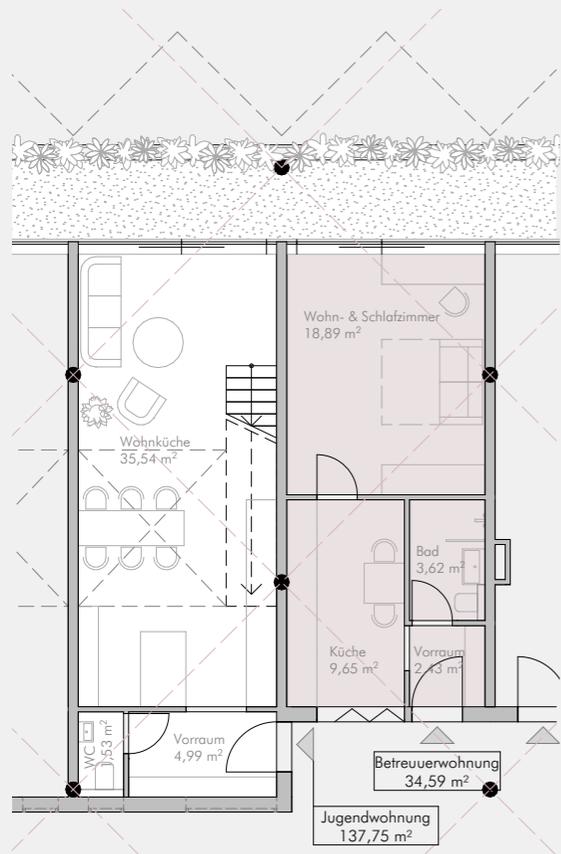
| Grundrisse des betreuten Jugendwohnens im Nordtrakt im Maßstab 1:150
